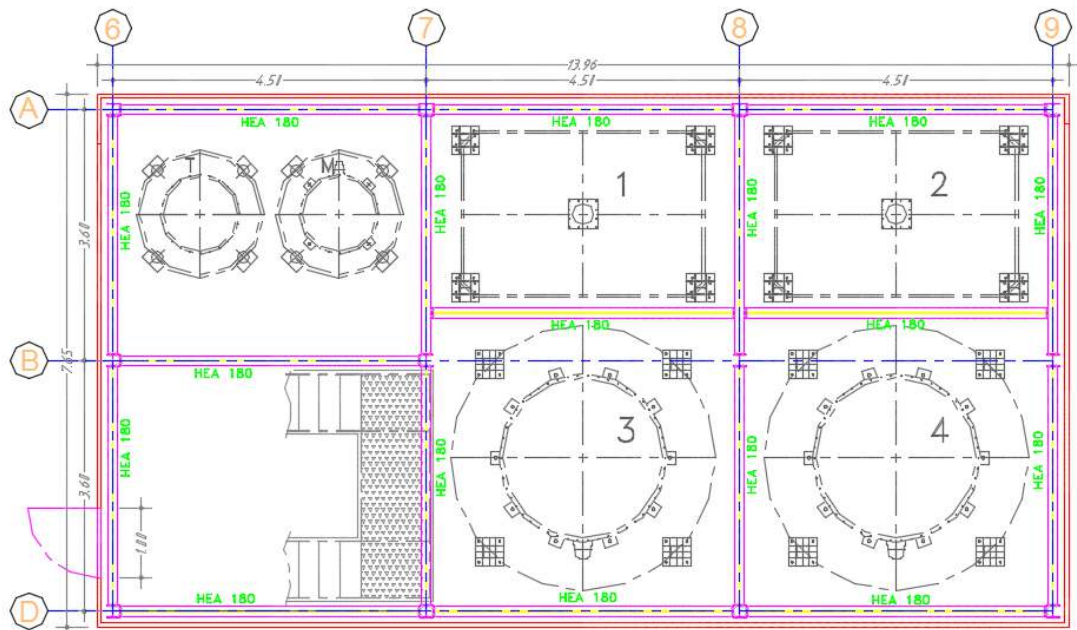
Vue en plan des Planchers Niveau +5.10 et +9.86
